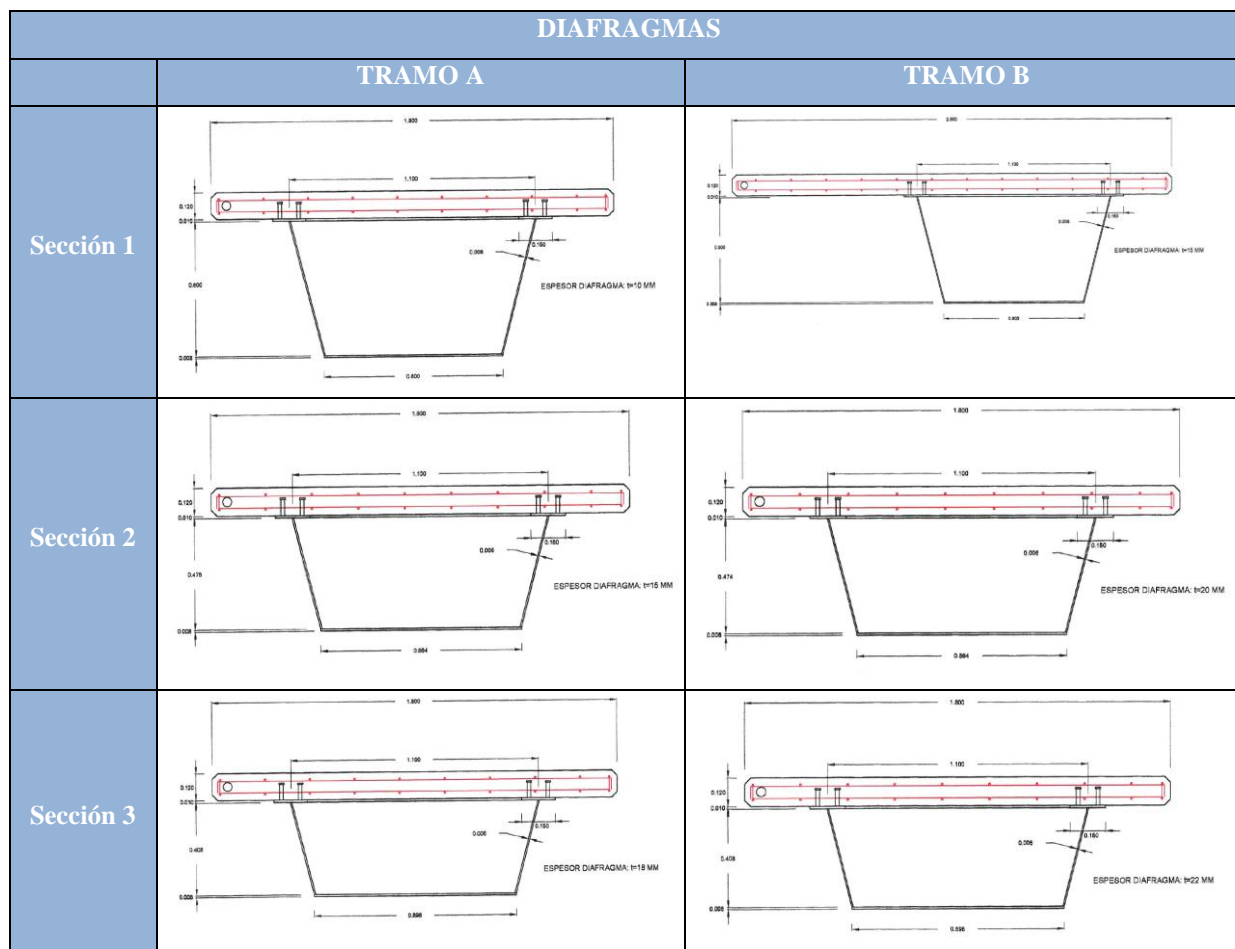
Detalle secciones planos originales. Tramo A y B.
